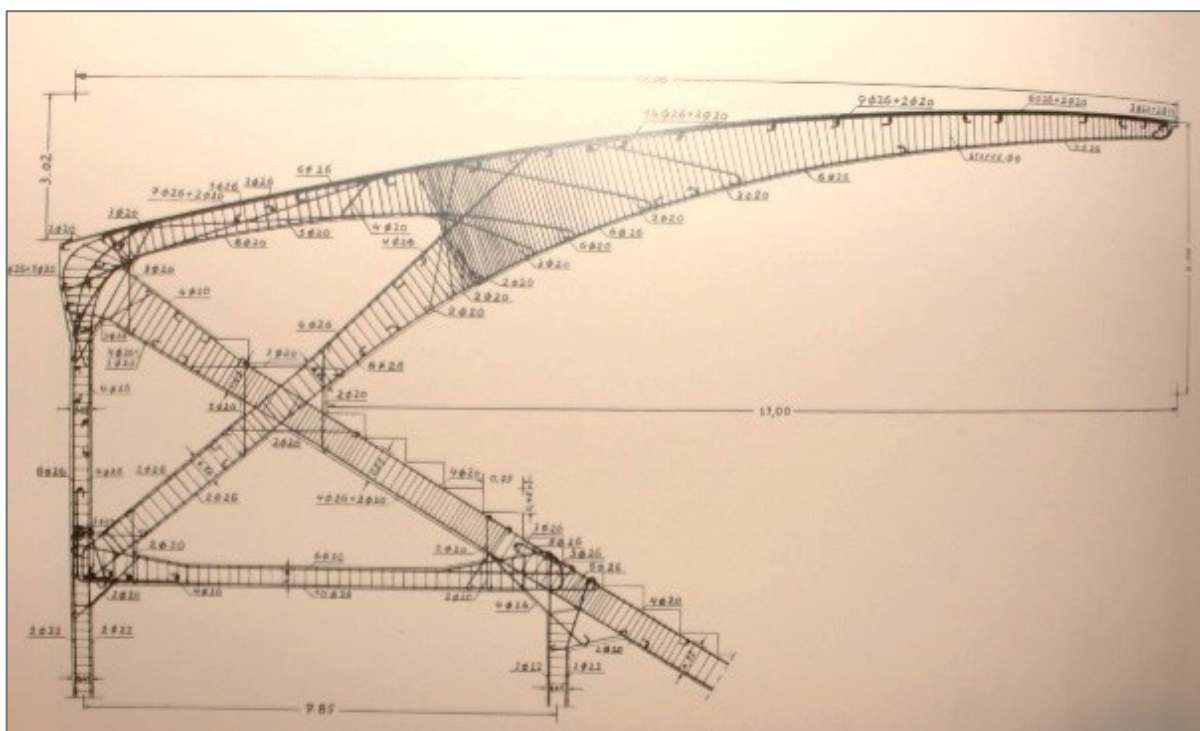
Tavola di progetto riportante una sezione strutturale della Tribuna Centrale e della pensilina (Archivio fotografico Barsotti, Firenze)
